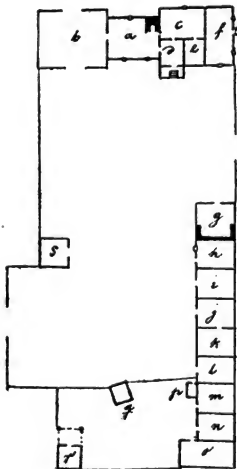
Grundriss eines estnischen Bauerhofes. Bal-tischport. Reval.
